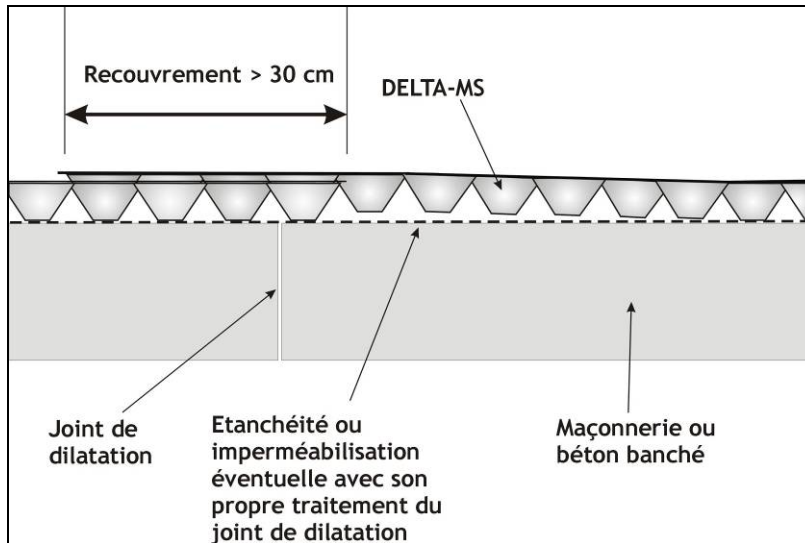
Joint de dilatation - Recouvrement du dernier lé (coupe horizontale)
